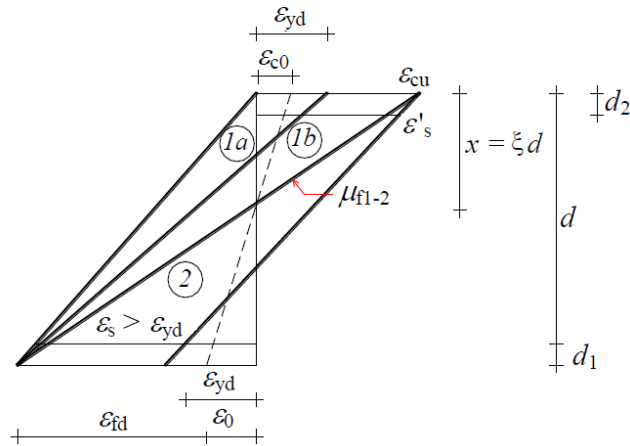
Campi di rottura di una sezione rettangolare di c.a. inflessa.
